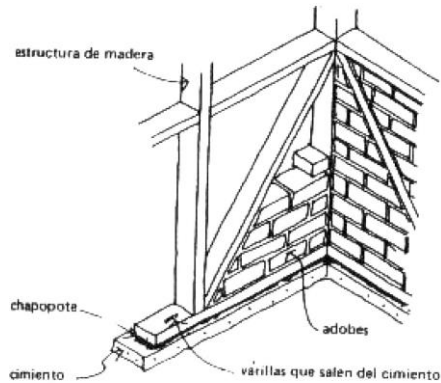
Encuentro de muro entramado con zócalo. Relleno de adobe.
